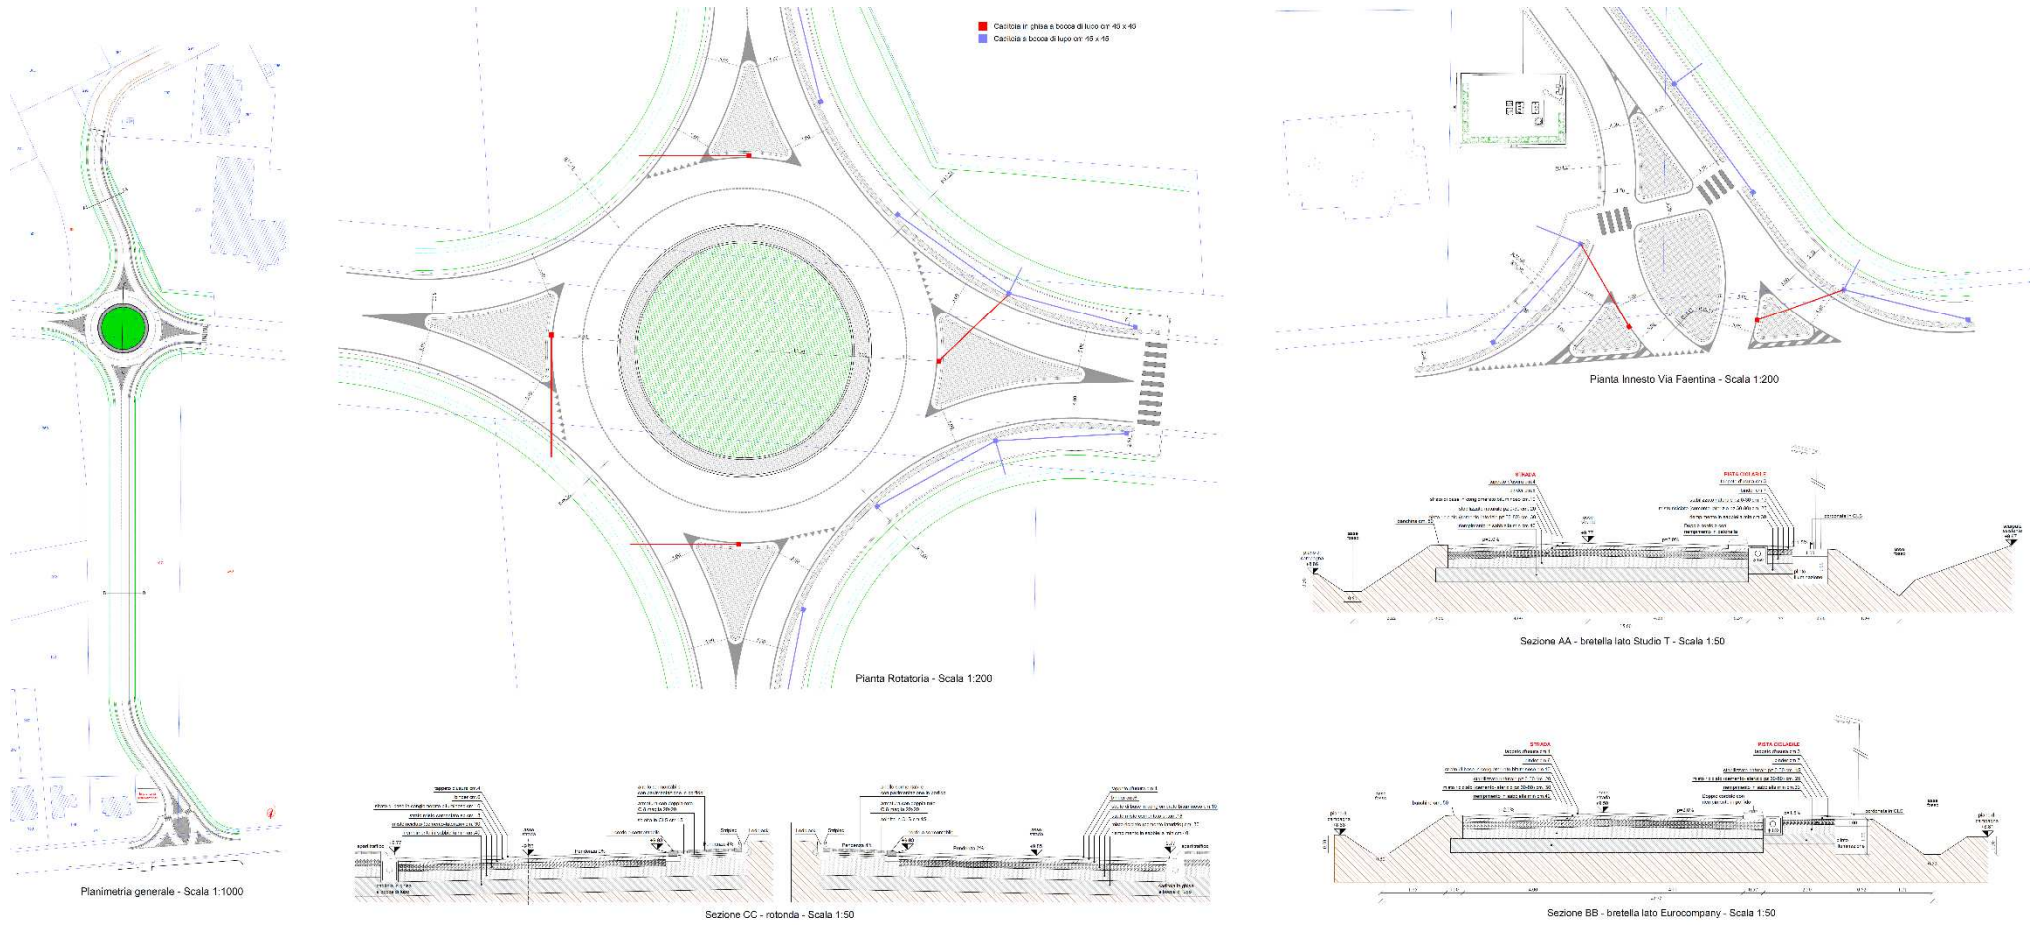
Estratto tavola 03 – Pianta e Sezioni di Progetto della strada
